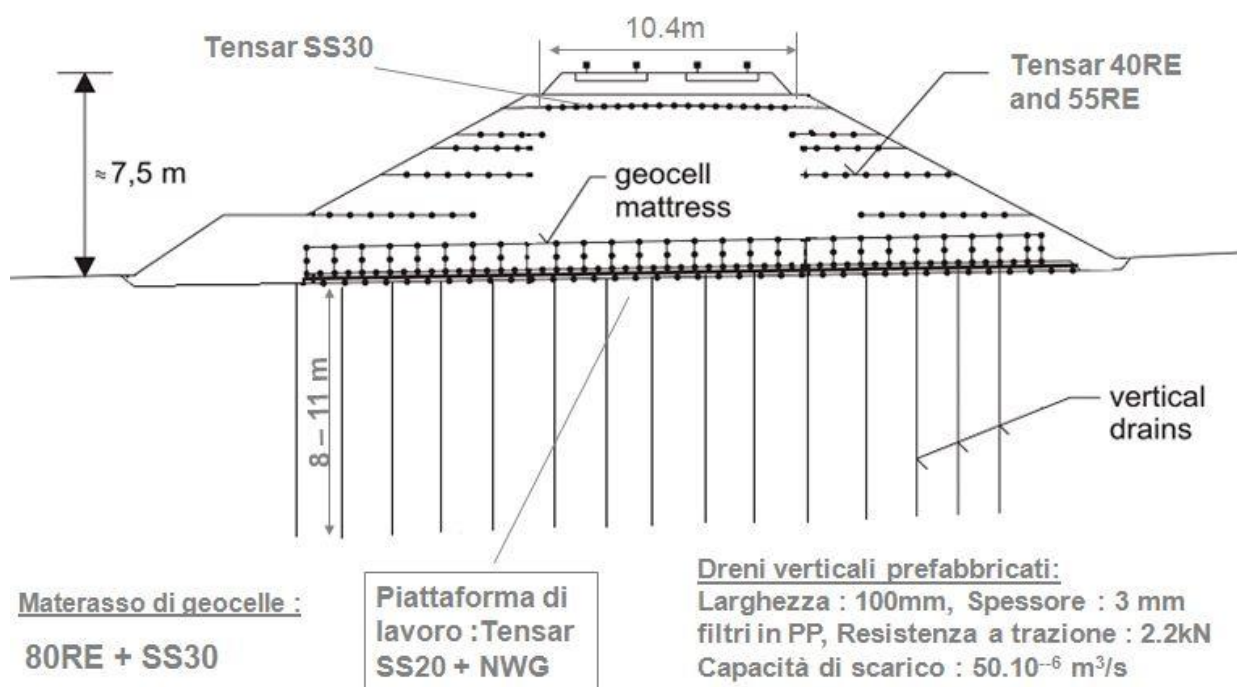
Sezione del rilevato con indicazione sui rinforzi e dreni impiegati
